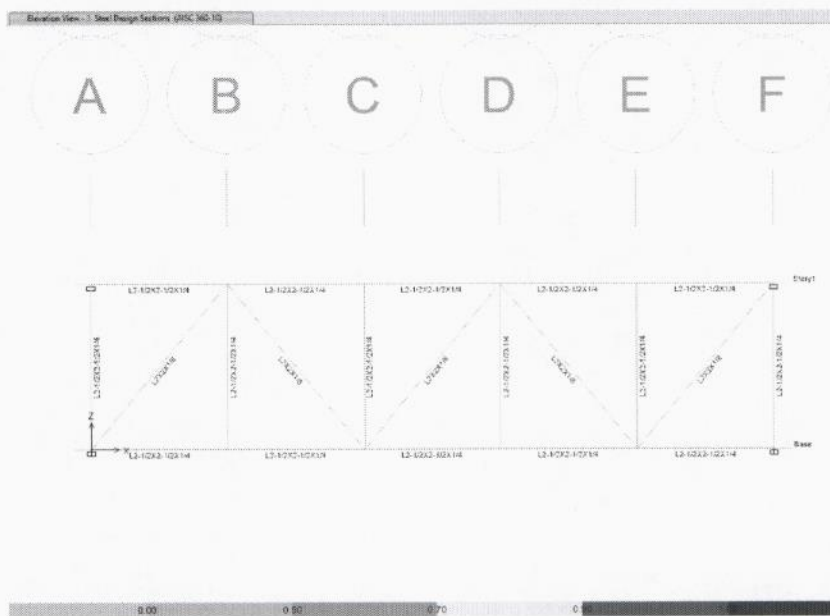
revisión estructura de acero tramo cubierta con paneles solares
